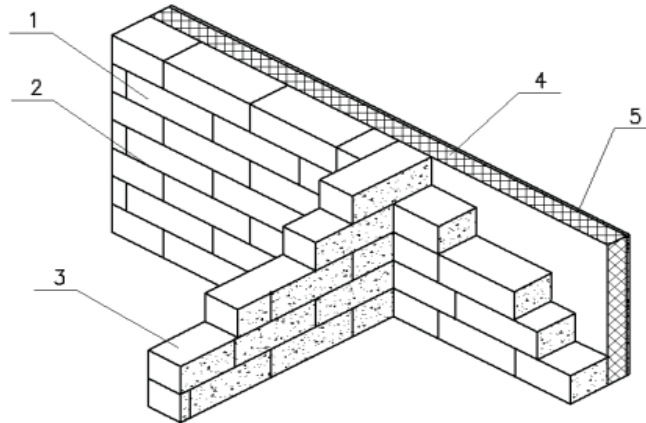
Фрагмент утеплення стіни. Де: 1- зовнішня стіна; 2-клей; 3 – внутрішня стіна; 4-мінераловатний утеплювач відповідно до розрахунку; 5- фасадна штукатурка.
